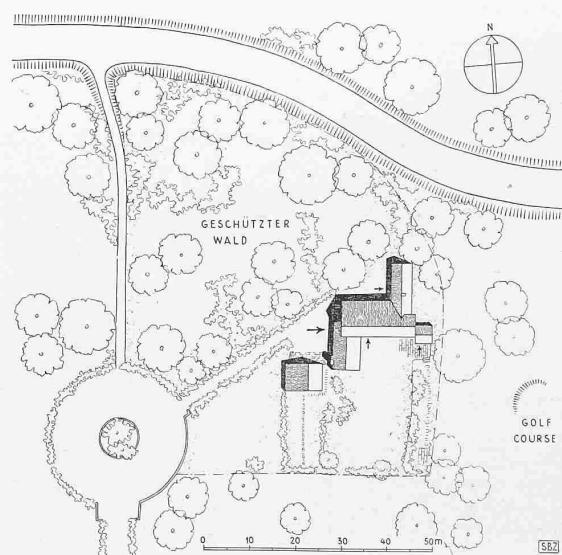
Landhaus in Moor Park, Herts. — Lageplan 1:1500
